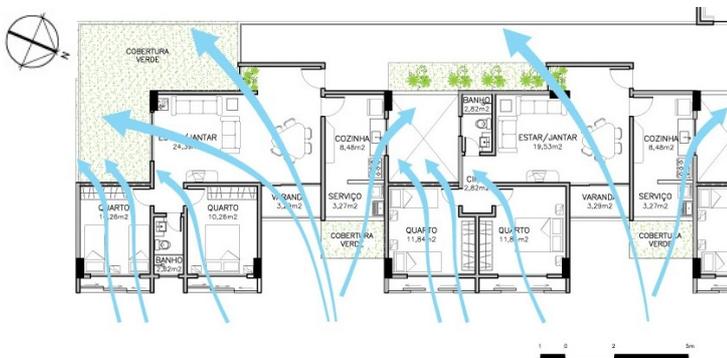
Secção da planta baixa do pavimento tipo do Bloco 1. Fonte: FANTICELE, 2008.
